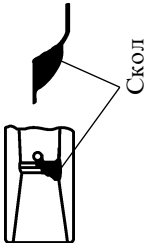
Подрельсовая зона анкерной железобетонной шпалы
